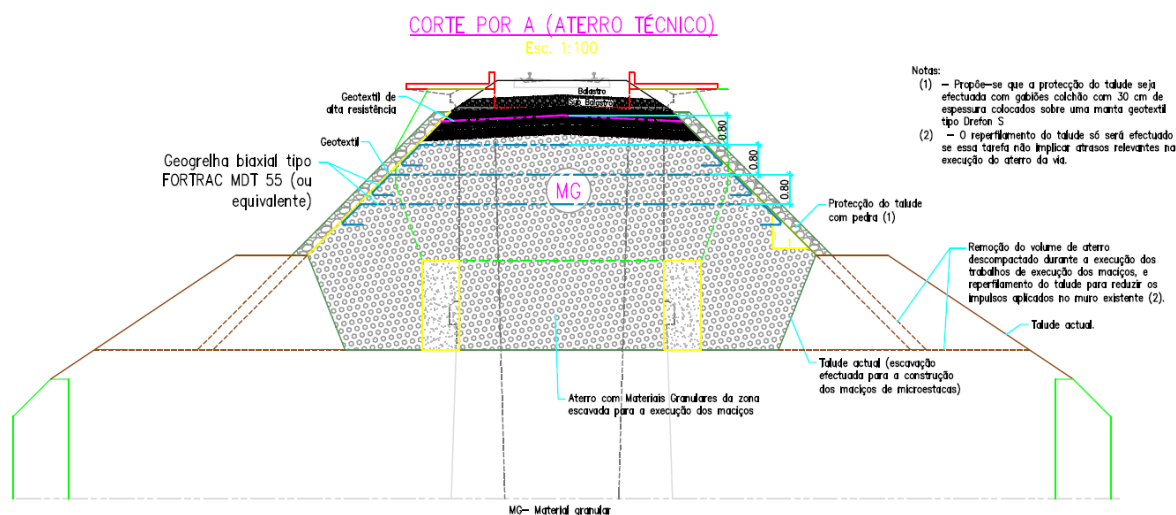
Ponte de Gogos: corte transversal da solução de reconstrução do aterro do encontro (TALprojecto, 2020)
